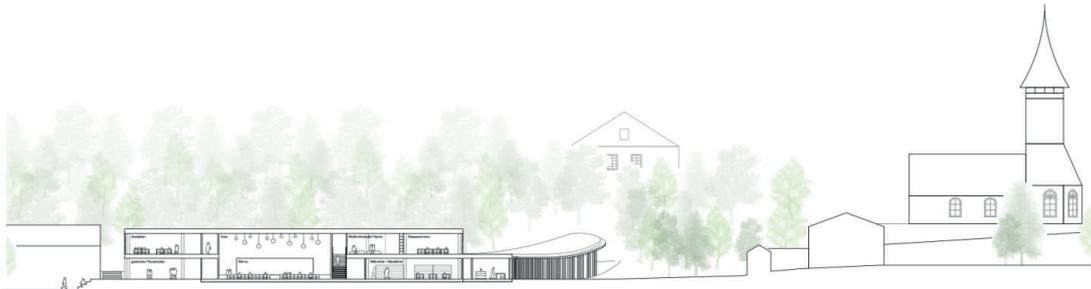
Querschnitt Schulgebäude mit zu Kirche ausgerichtetem, schwungförmigem Anbau für die Kirchenräumlichkeiten
